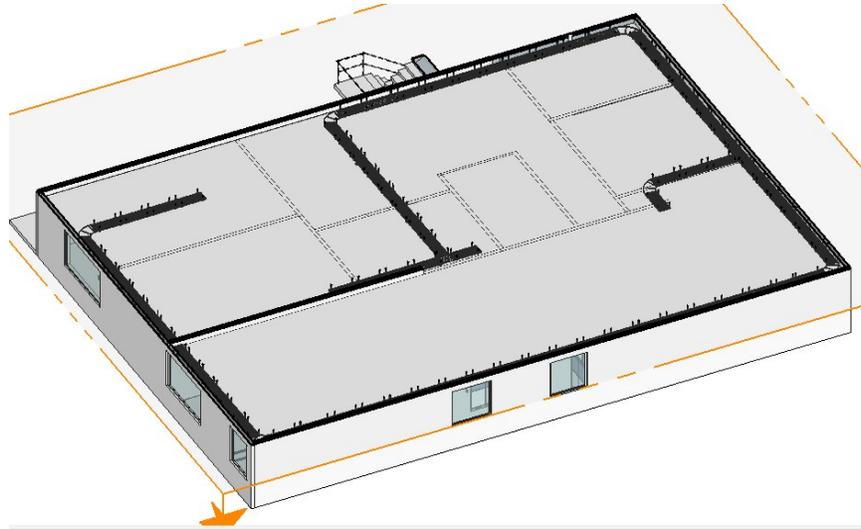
Corte Transversal de la Escalerilla Primer Piso 3D en SketchUp
